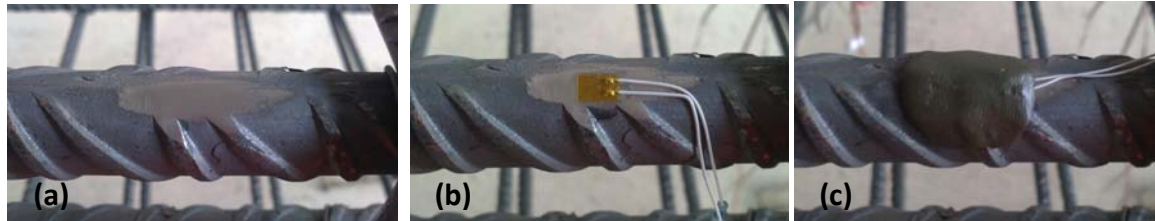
Galga extensométrica en armado interior. a) preparación de la superficie de la armadura, b) galga colocada en dirección longitudinal, c) protección de la galga
